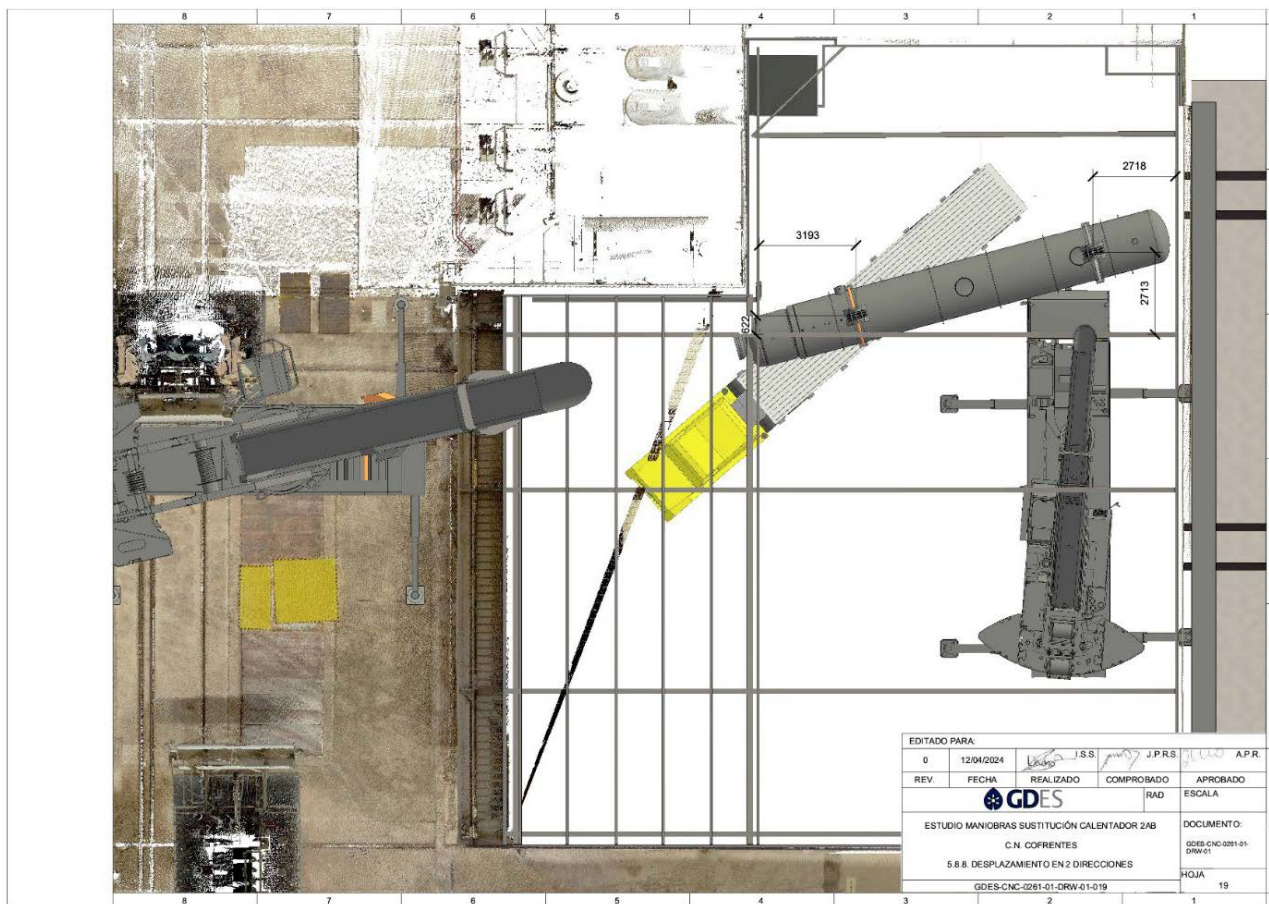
Plano detalle de la secuencia de maniobras necesarias para la extracción.
